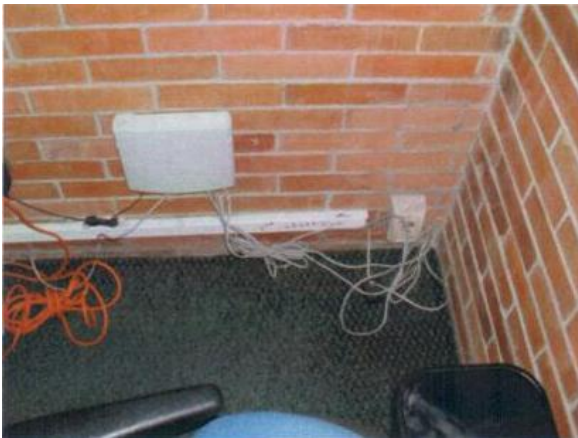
y 6.1.8.31 Switch y cableado en mal estado dentro del Rack de Rectoría
